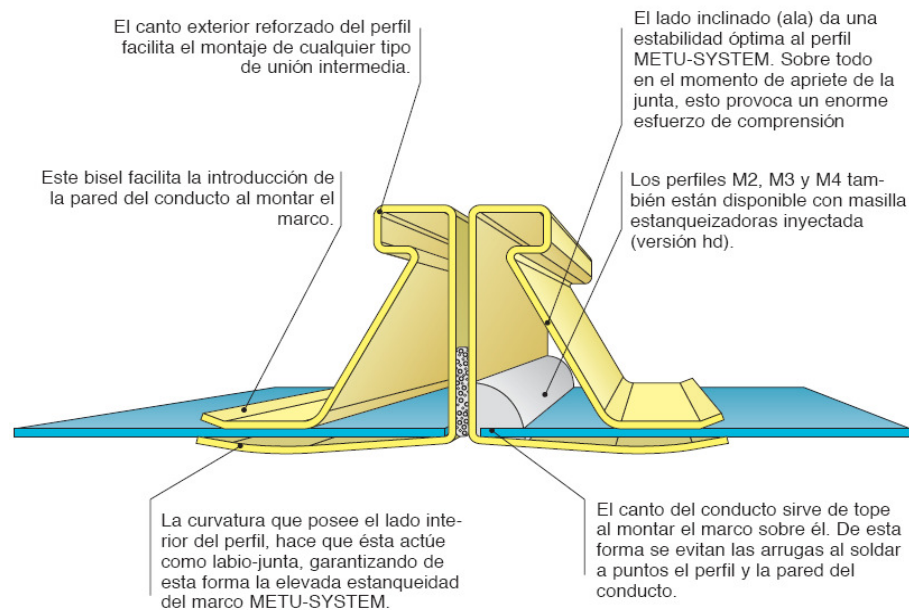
Unión tipo METU para conducto de geometría rectangular.
